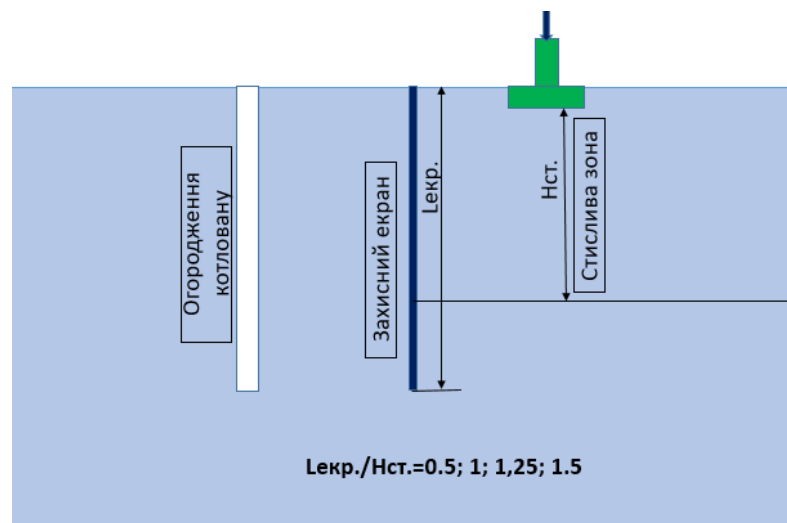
Розрахункова схема при дослідженні впливу довжини захисного екрану по відношенню до глибини стисливої зони фундаменту існуючої будівлі
